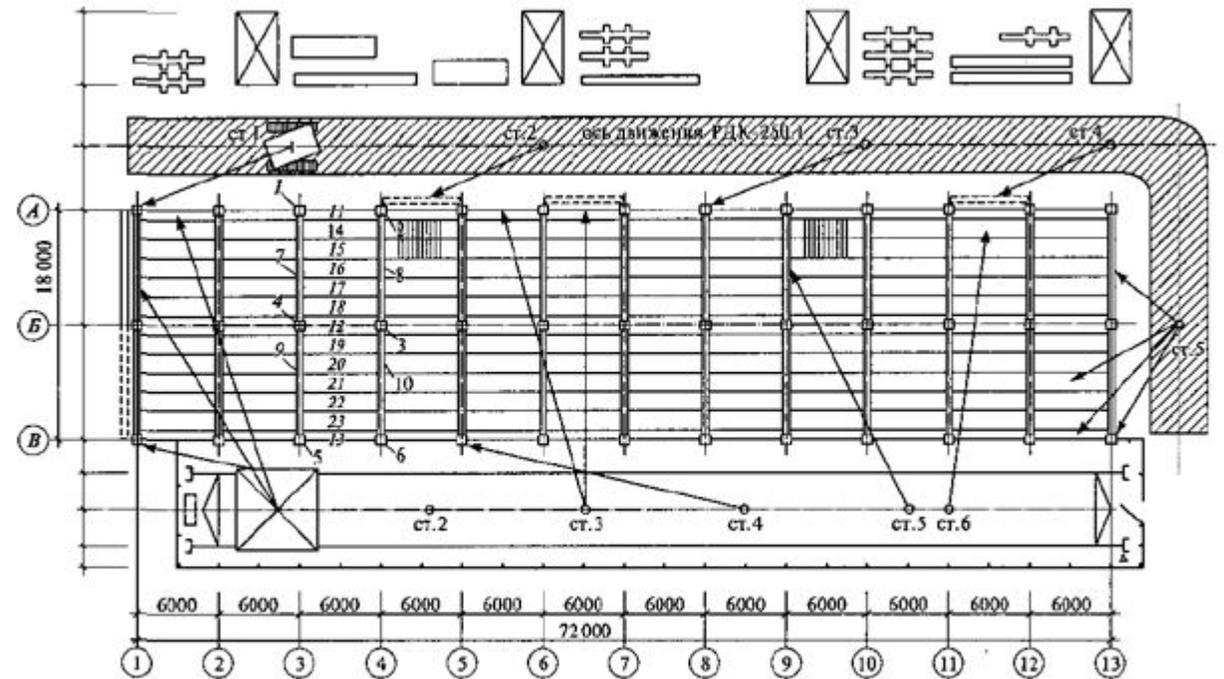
Фрагмент стройгенплана на период монтажа надземных конструкций многоэтажного каркасного здания:
